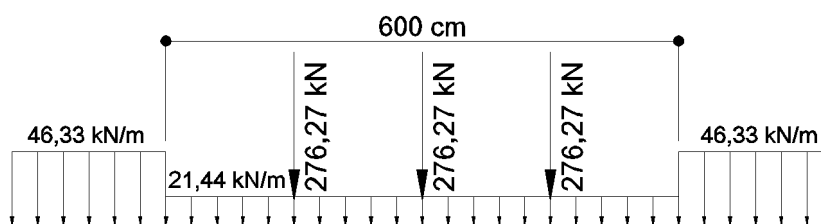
Esquema estático para cargas permanentes – obra final (medidas em cm)
